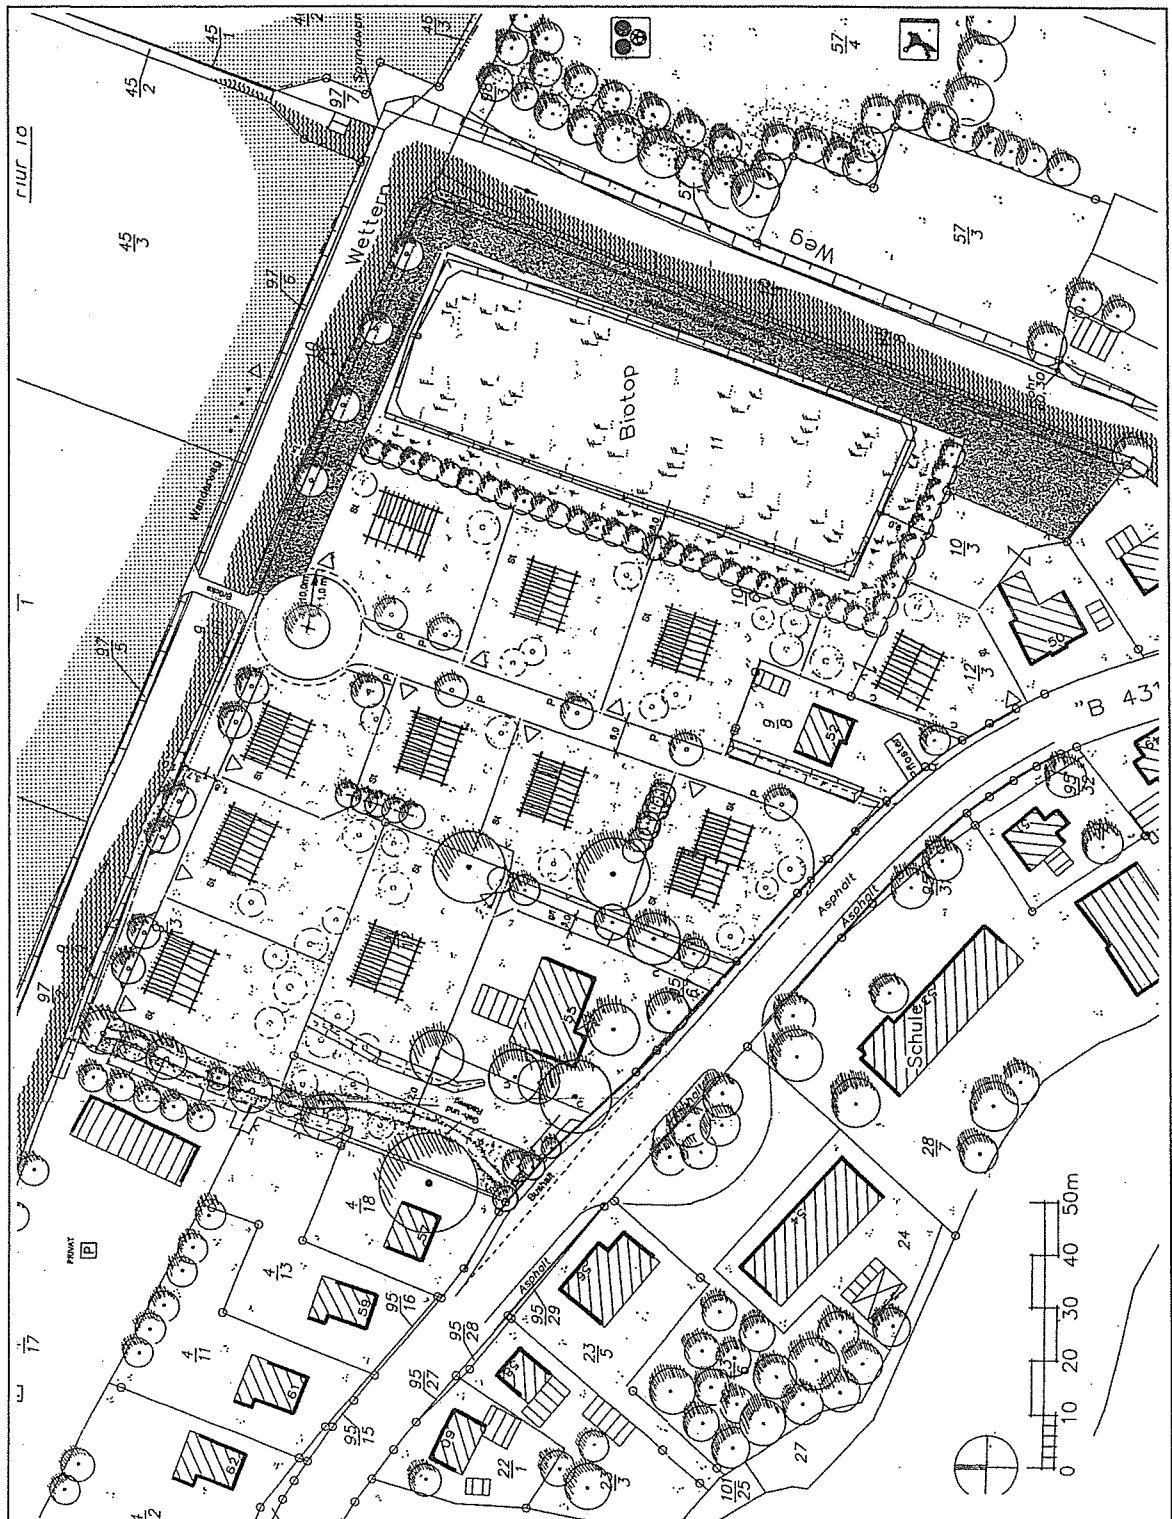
„Städtebauliches Konzept“ zum Bauungsplan Nr. 8 „Weide Westphalen“ vom 26.03.2000, ergänzt am 21.05.2001, als Planungsgrundlage für den Bauungsplan nunmehr als Satzung, unmaßstäblich
